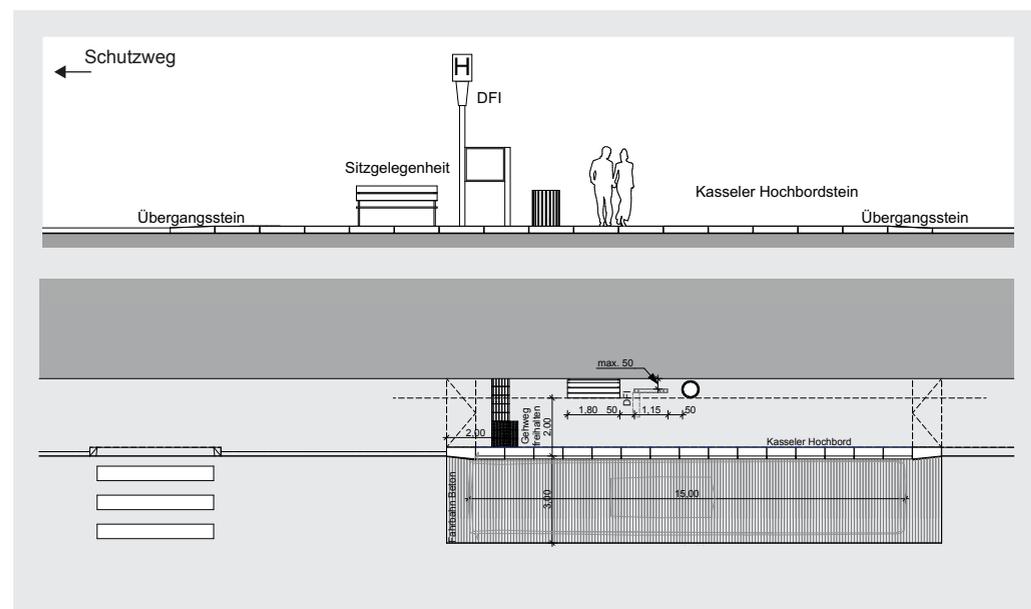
Längsschnitt und Lageplan inkl. Sitzgelegenheit und Mülleimer (Plan: AAPS – Atelier für Architektur ZT GmbH)
